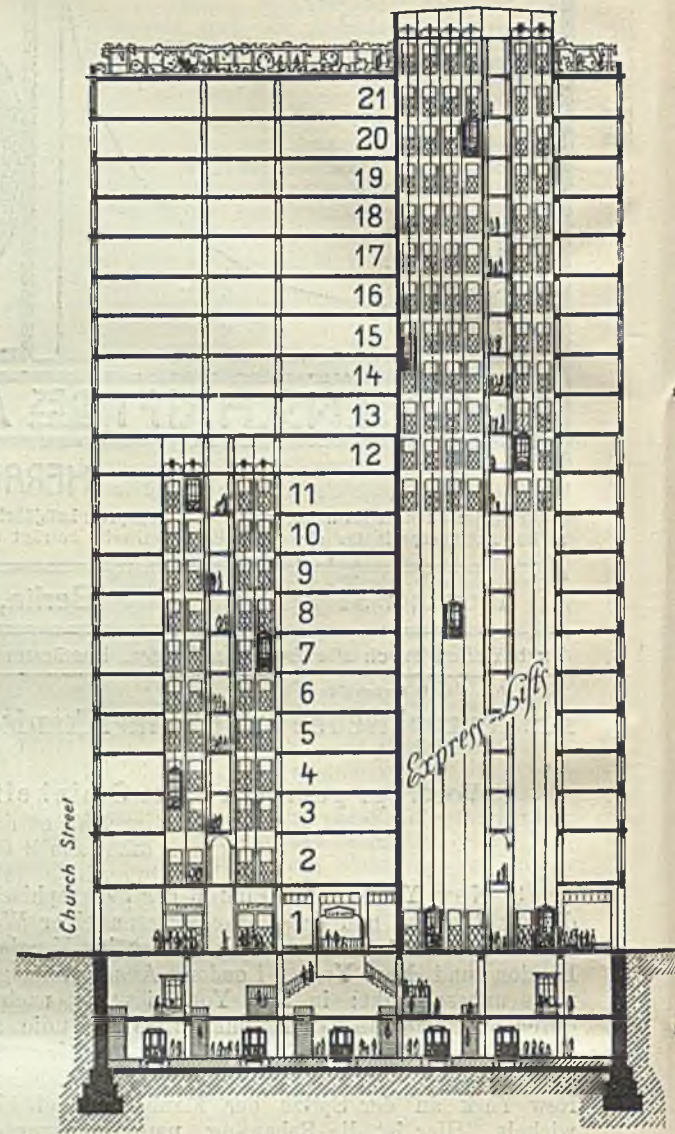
New York: Untergrundbahnstrecke an der City Hall
